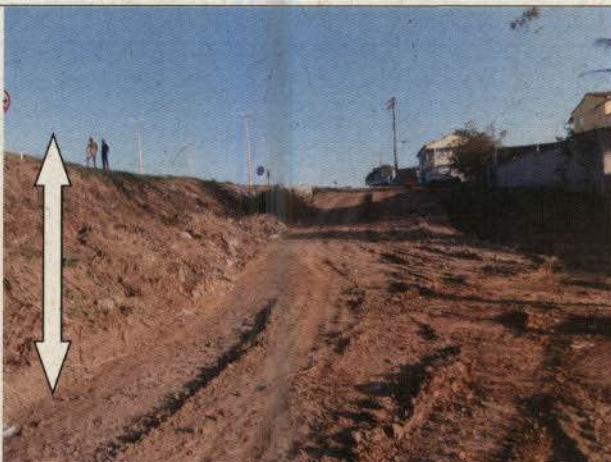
vista do talude formado pelo corte para instalar a estrada.
